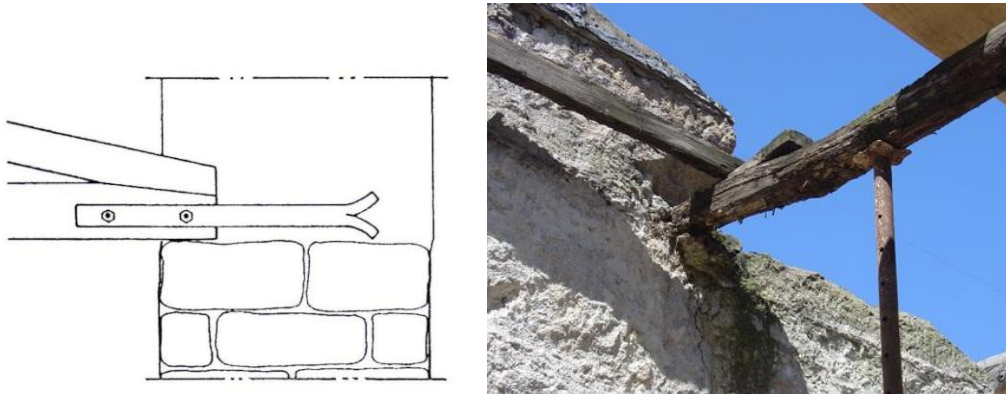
Apoio de vigas na alvenaria [5, 14]
